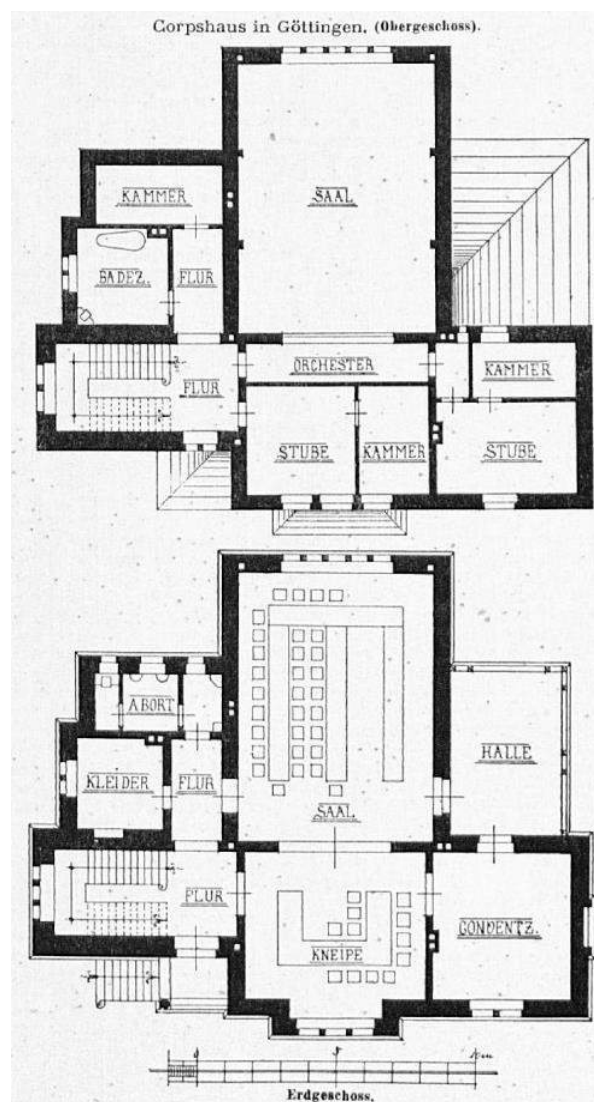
Grundriss des Corpshauses Brunsviga Göttingen
